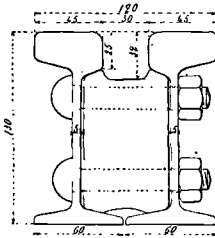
Coupe transversale de la voie Haarmann (Frankfort).
